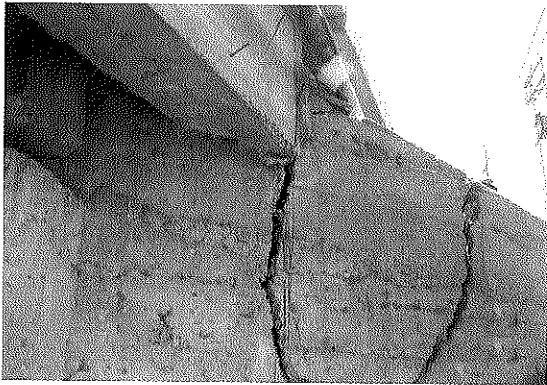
Grietas en la aleta por asentamientos y socavación. Puente Venecia en Boyacá
